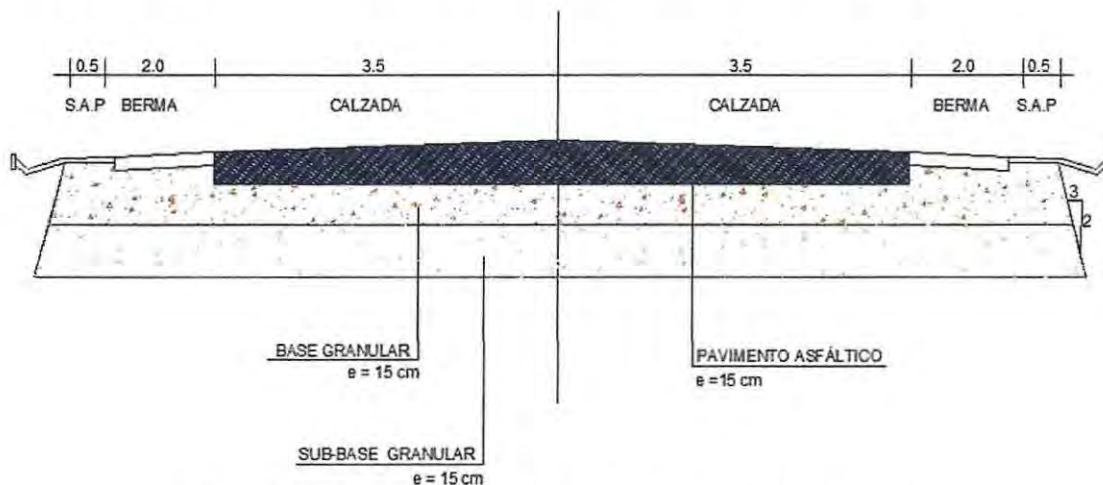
Esquema de la estructura de pavimento flexible, caso N°3
